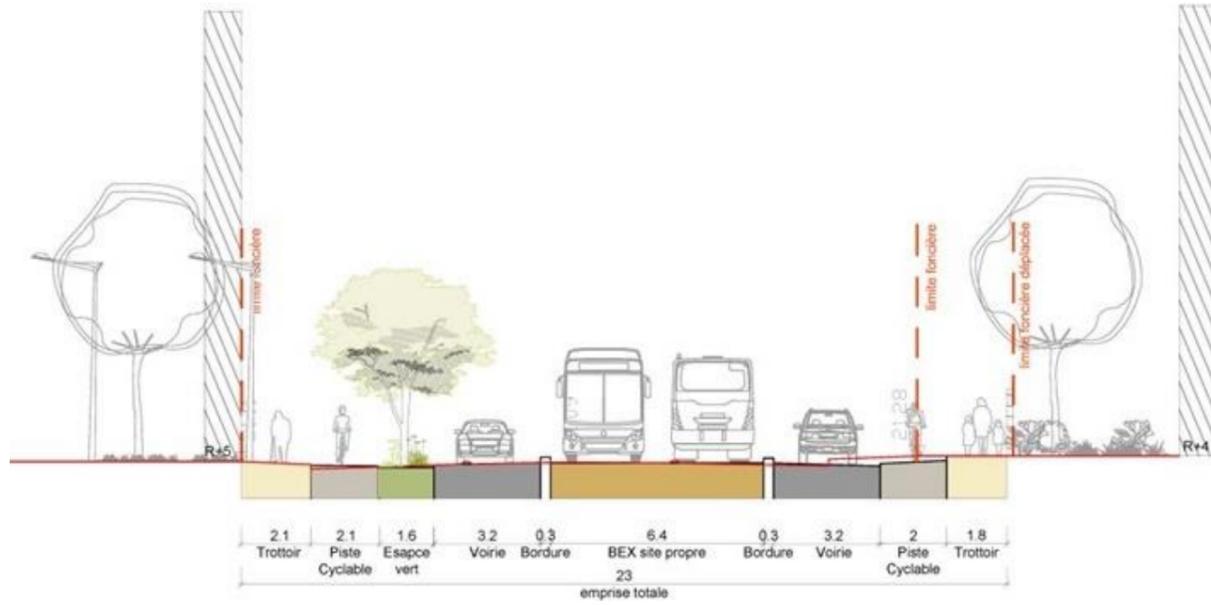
Coupe type sur la rue du Tauszin en section courante
